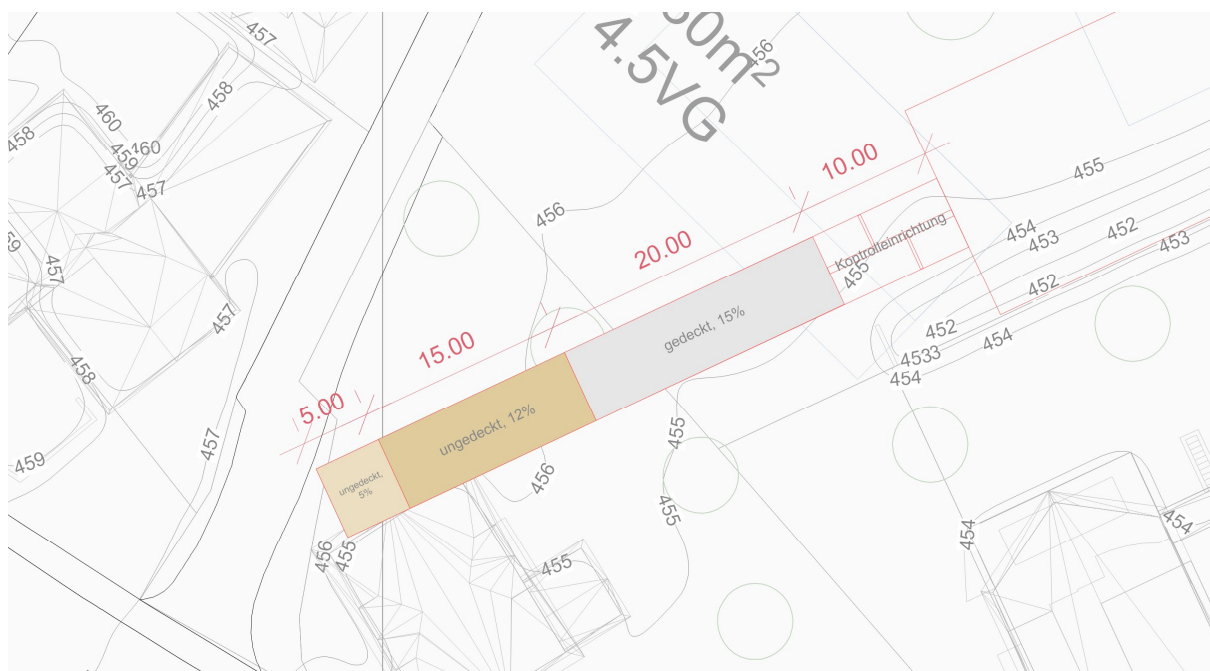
Situation Rampe auf Hübeliweg (Anschlusspunkt 456.5, Rampenlänge: 40 m +10 m Länge für Kontrolleinrichtungen)
